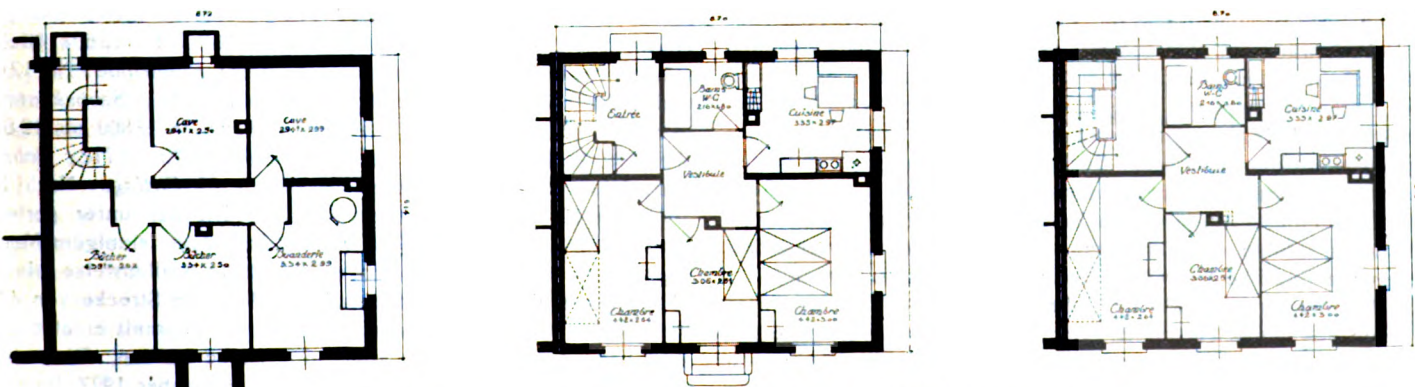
Zweifamilienhaus Typ B. Grundrisse 1:200. — Architekten Gilliard & Godet in Lausanne.
